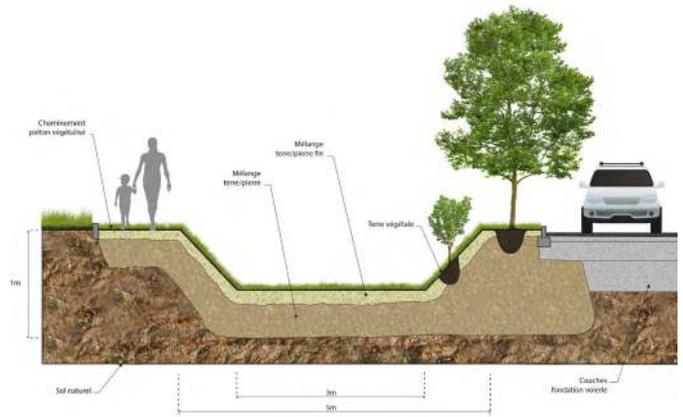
schéma d'une coupe transversale de noue en terre-pierre
